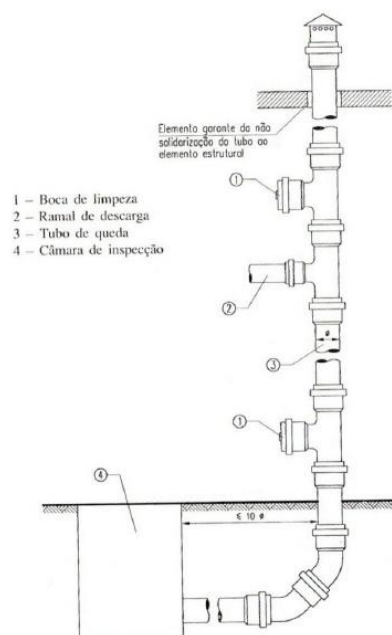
Ligação do tubo de queda à câmara de inspeção (Pedroso, 2016)
